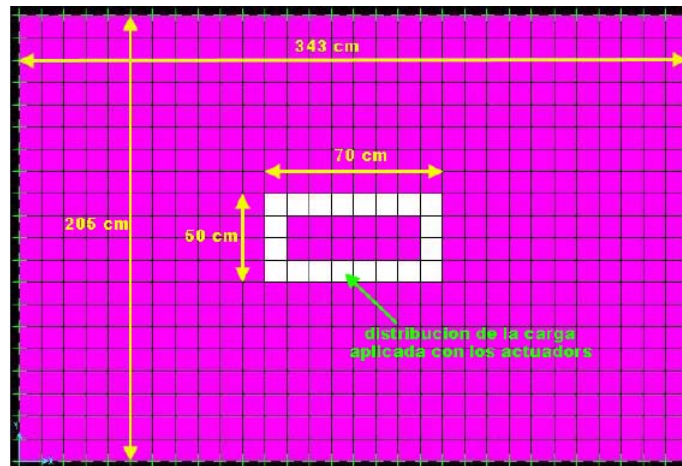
Vista en planta del sistema losahabit modelado con la técnica del "elemento finito"
